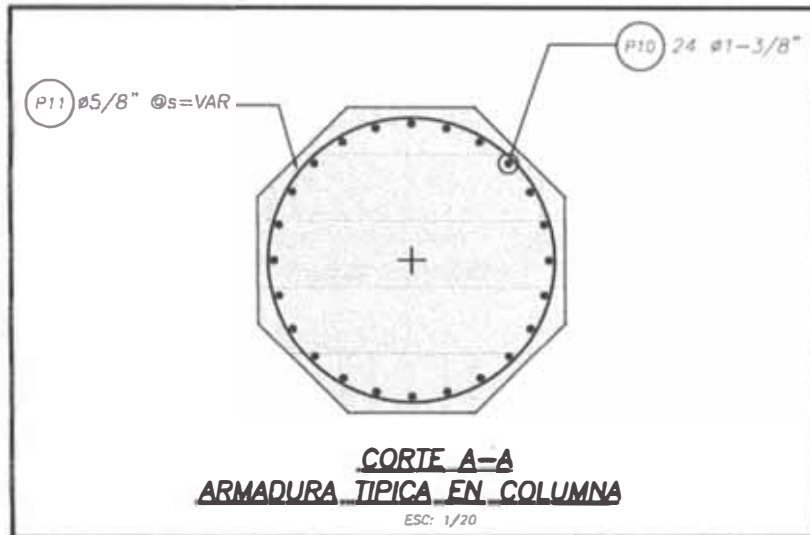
Sección Transversal de la columna S49P y S51P
